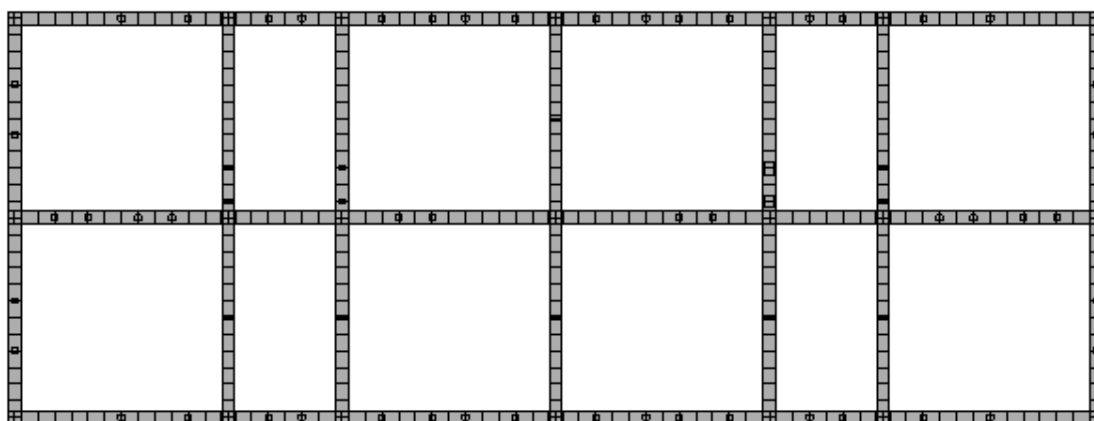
Схема расположения несущих кирпичных стен этажа в плане
